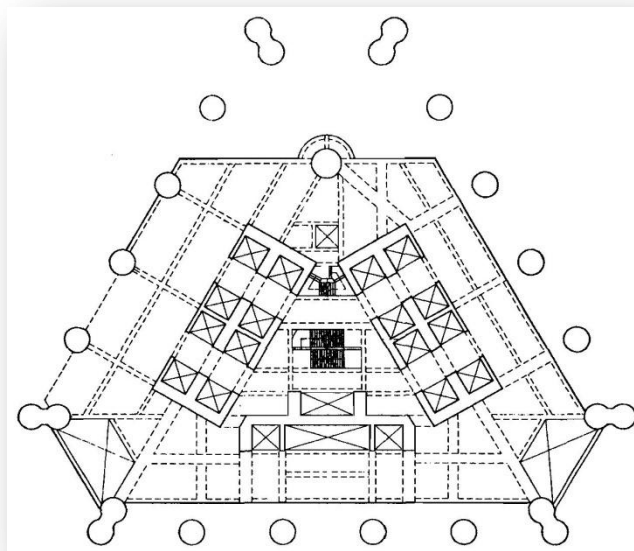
Planta del 2º piso, se pueden apreciar las columnas circulares (perímetro) y los muros del núcleo.
